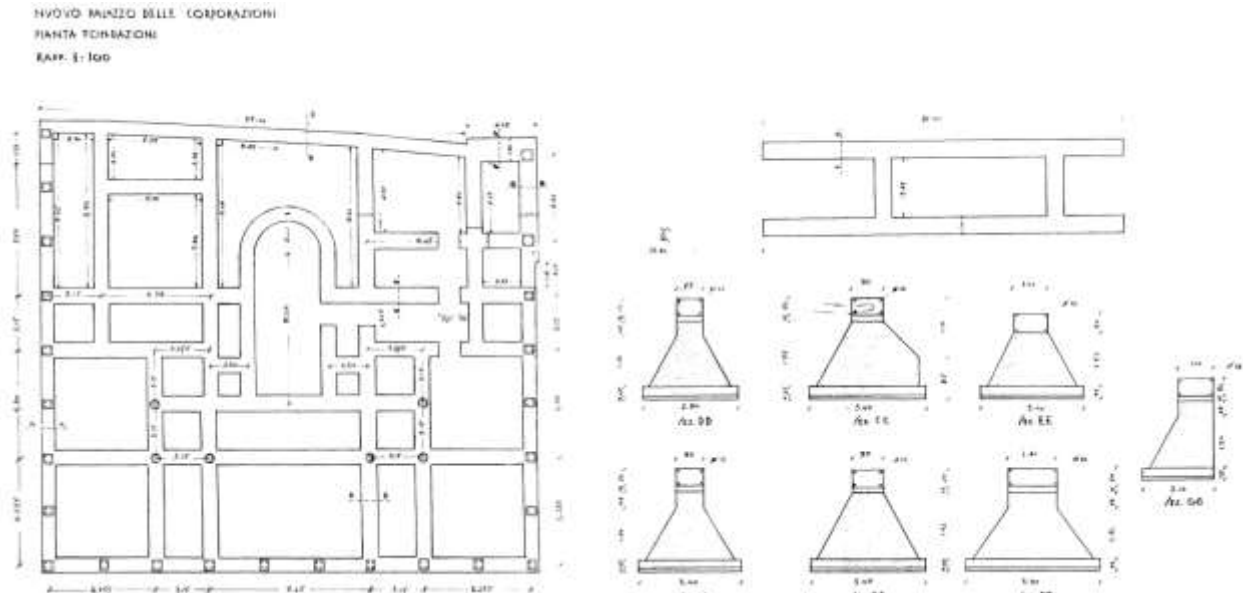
Pianta delle fondazioni e indicazione delle sezioni adottate per le travi di fondazione (progetto preliminare).
